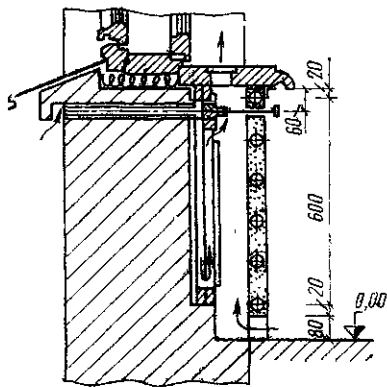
Установка подоконной отопительной панели с каналом для подачи и подогрева наружного воздуха
